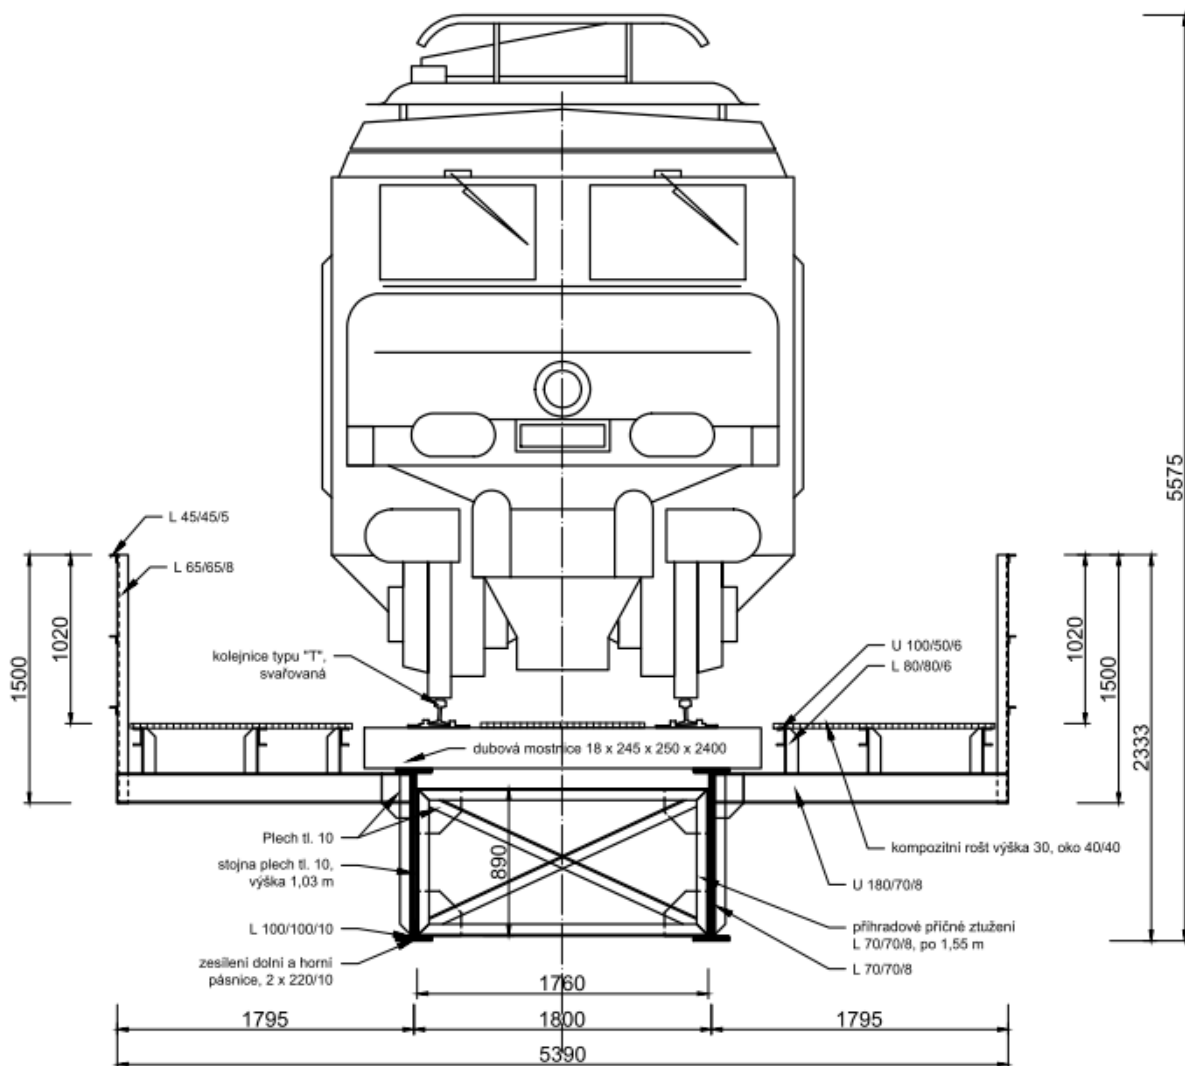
Detail příčného vyztužení mostní konstrukce
